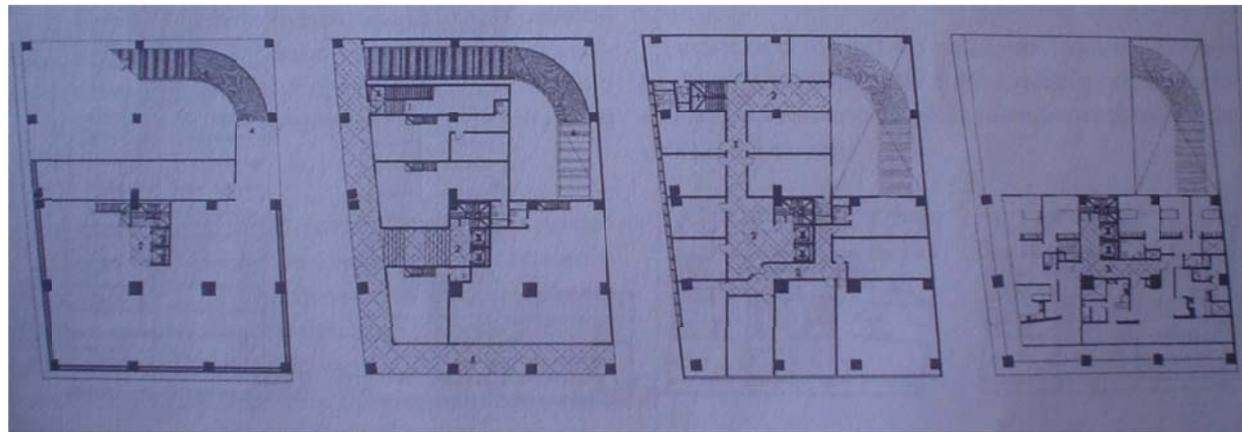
Planta sótano, planta baja, primer alto y segundo alto. Fuente: Tesis Lata Guamán, Oswaldo. ALAMIRO GONZÁLEZ. OBRAS Y PROYECTOS ENTRE 1960-1970
